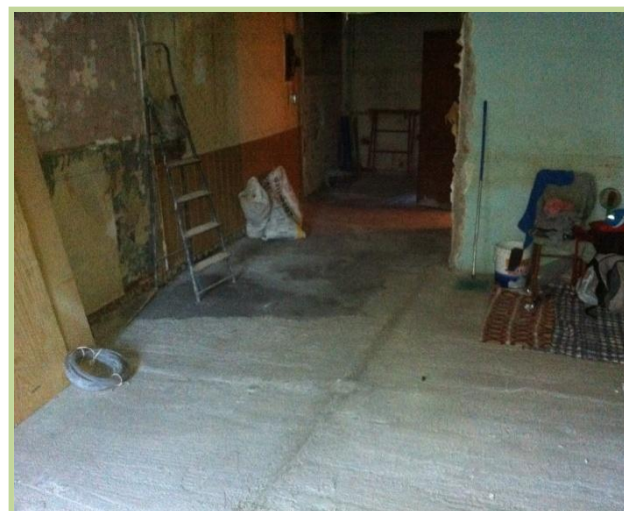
Imagen de la zona interior de la vivienda tipo diáfana, antes de iniciar la fase 2.
